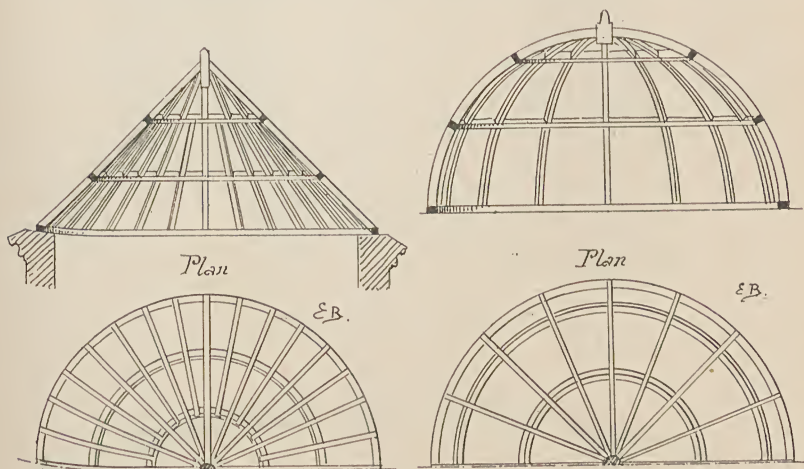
, 725, 726, 727. — Combles conique et en coupole.
